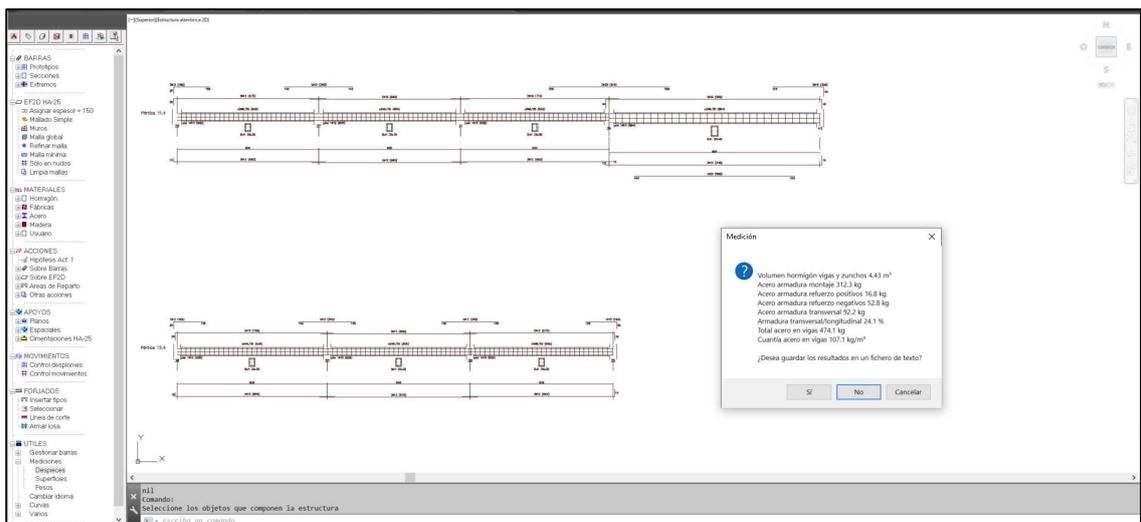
Medición correspondiente a varias vigas de hormigón armado
